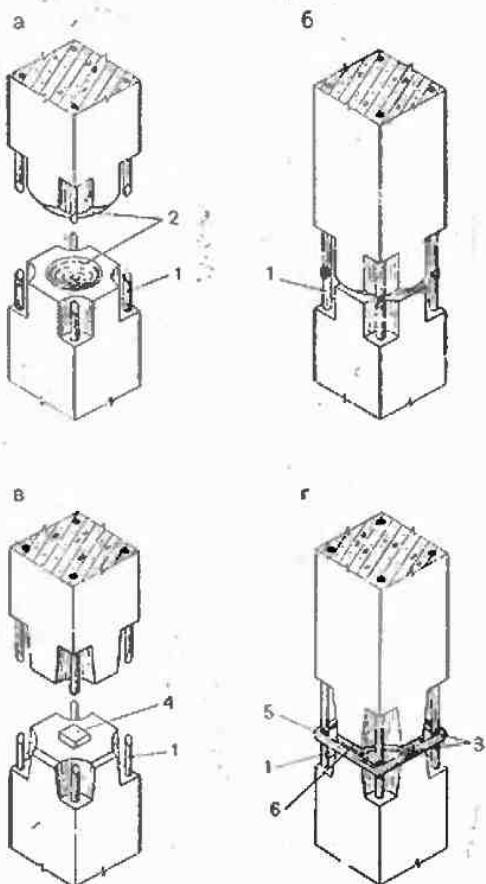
Стыки железобетонных колонн, передающие усилия через бетон
